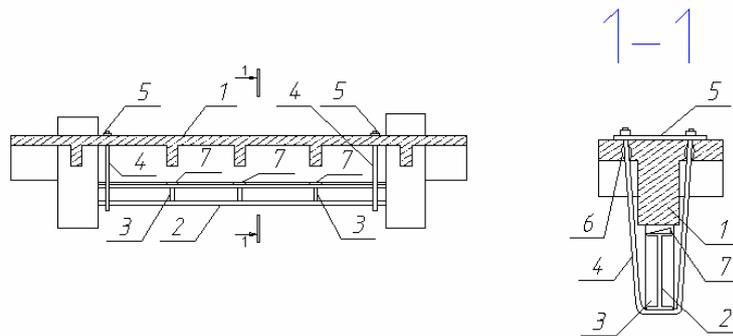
Усиление балок монолитного железобетонного перекрытия подведением разгружающих балок на хомутах: 1 – усиливаемая балка; 2 – разгружающая металлическая балка; 3 – ребра жесткости; 4 – хомуты для крепления разгружающей балки; 5 – пластина-держатель хомутов; 6 – отверстия, просверленные в плите для пропуска хомутов; 7 – пластины клинья для включения разгружающих балок в работу
